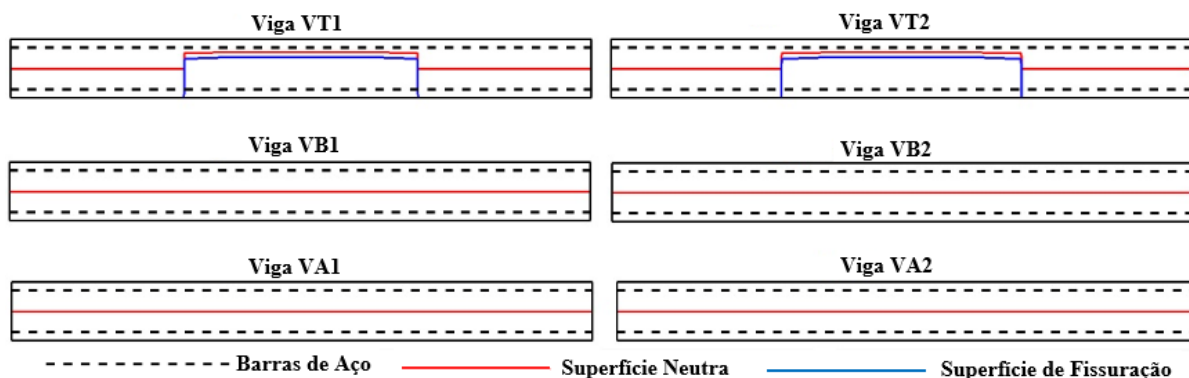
Região de fissuração das vigas ensaiadas por Baroni (2003). Fonte: O Autor (2016).
